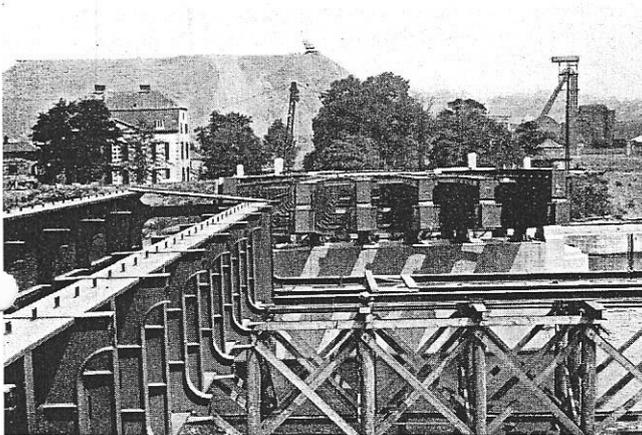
Montage du pont. On voit l'extrémité des bras cantilever de la travée centrale.
